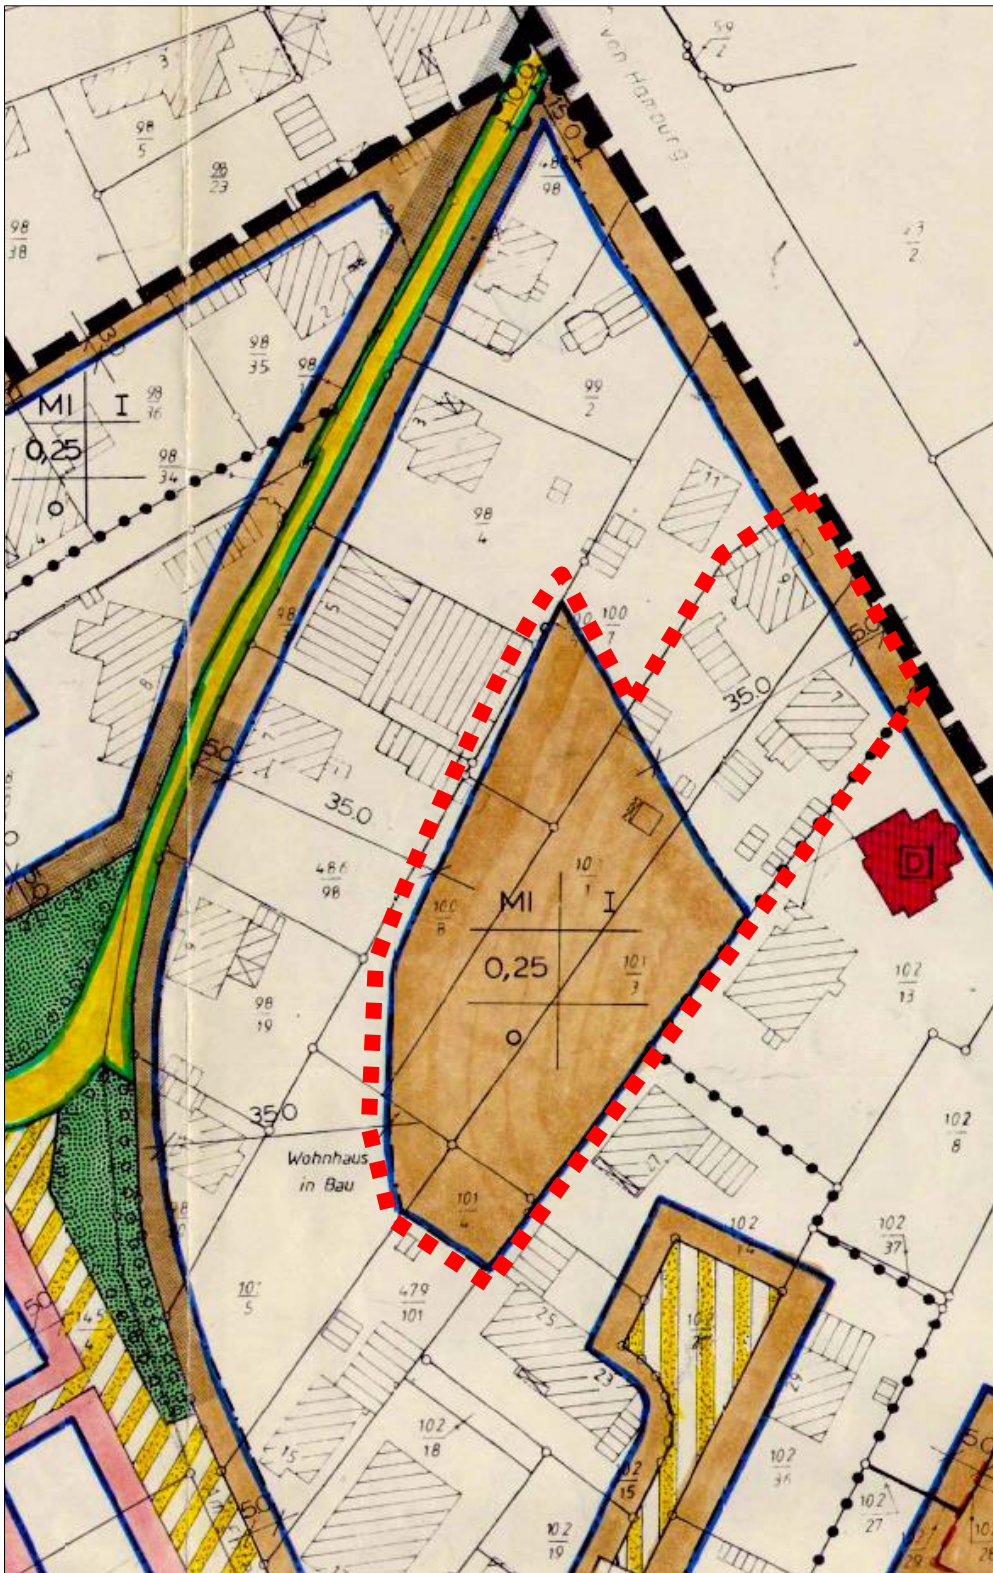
Bebauungsplan Bardowick Nr. 10 „Heereskamp“ mit örtl. Bauvorschrift, Auszug, rote Markierung= Lage 5. Änderung
